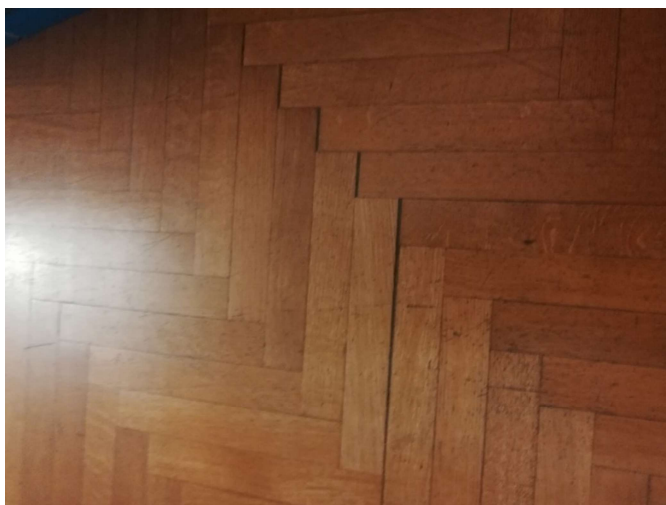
Palazzo Ossoli – pavimentazione in parquet di rover ambiente 5 piano primo
